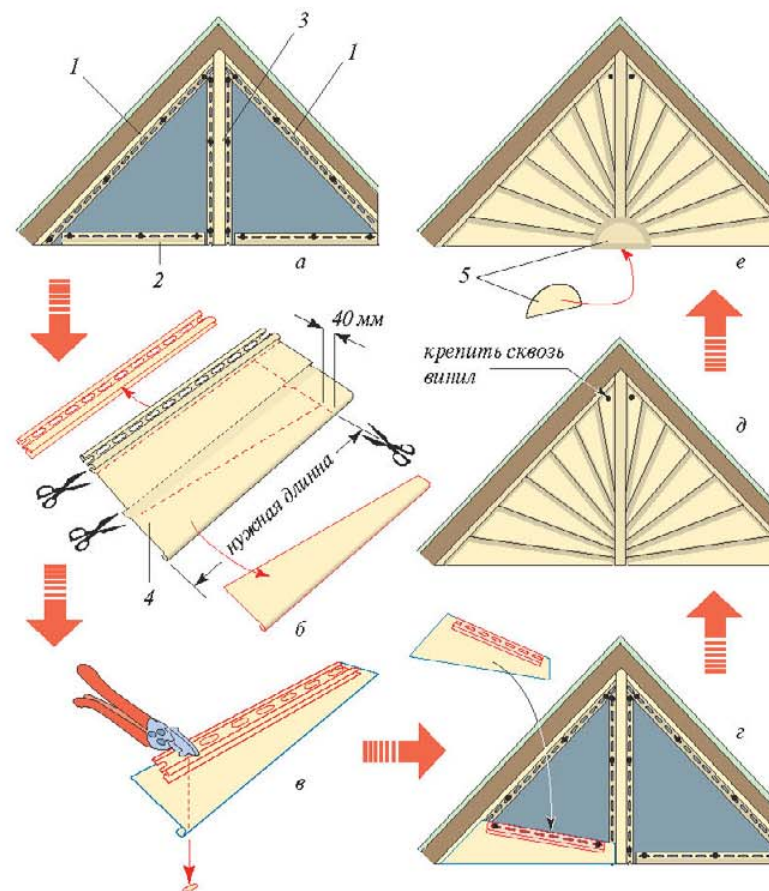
Изготовление декоративной виниловой обшивки «солнце»: а — установка профилей обвязки; б — изготовление «луча»; в — пробивка на «луче» гвоздевых отверстий; г, д — монтаж «лучей»; е — монтаж «солнечного диска»; 1 — J-профили (или внутренние угловые профили); 2 — стартовый профиль; 3 — П-профиль; 4 — кусок рядового сайдинга; 5 — «солнечный диск»
